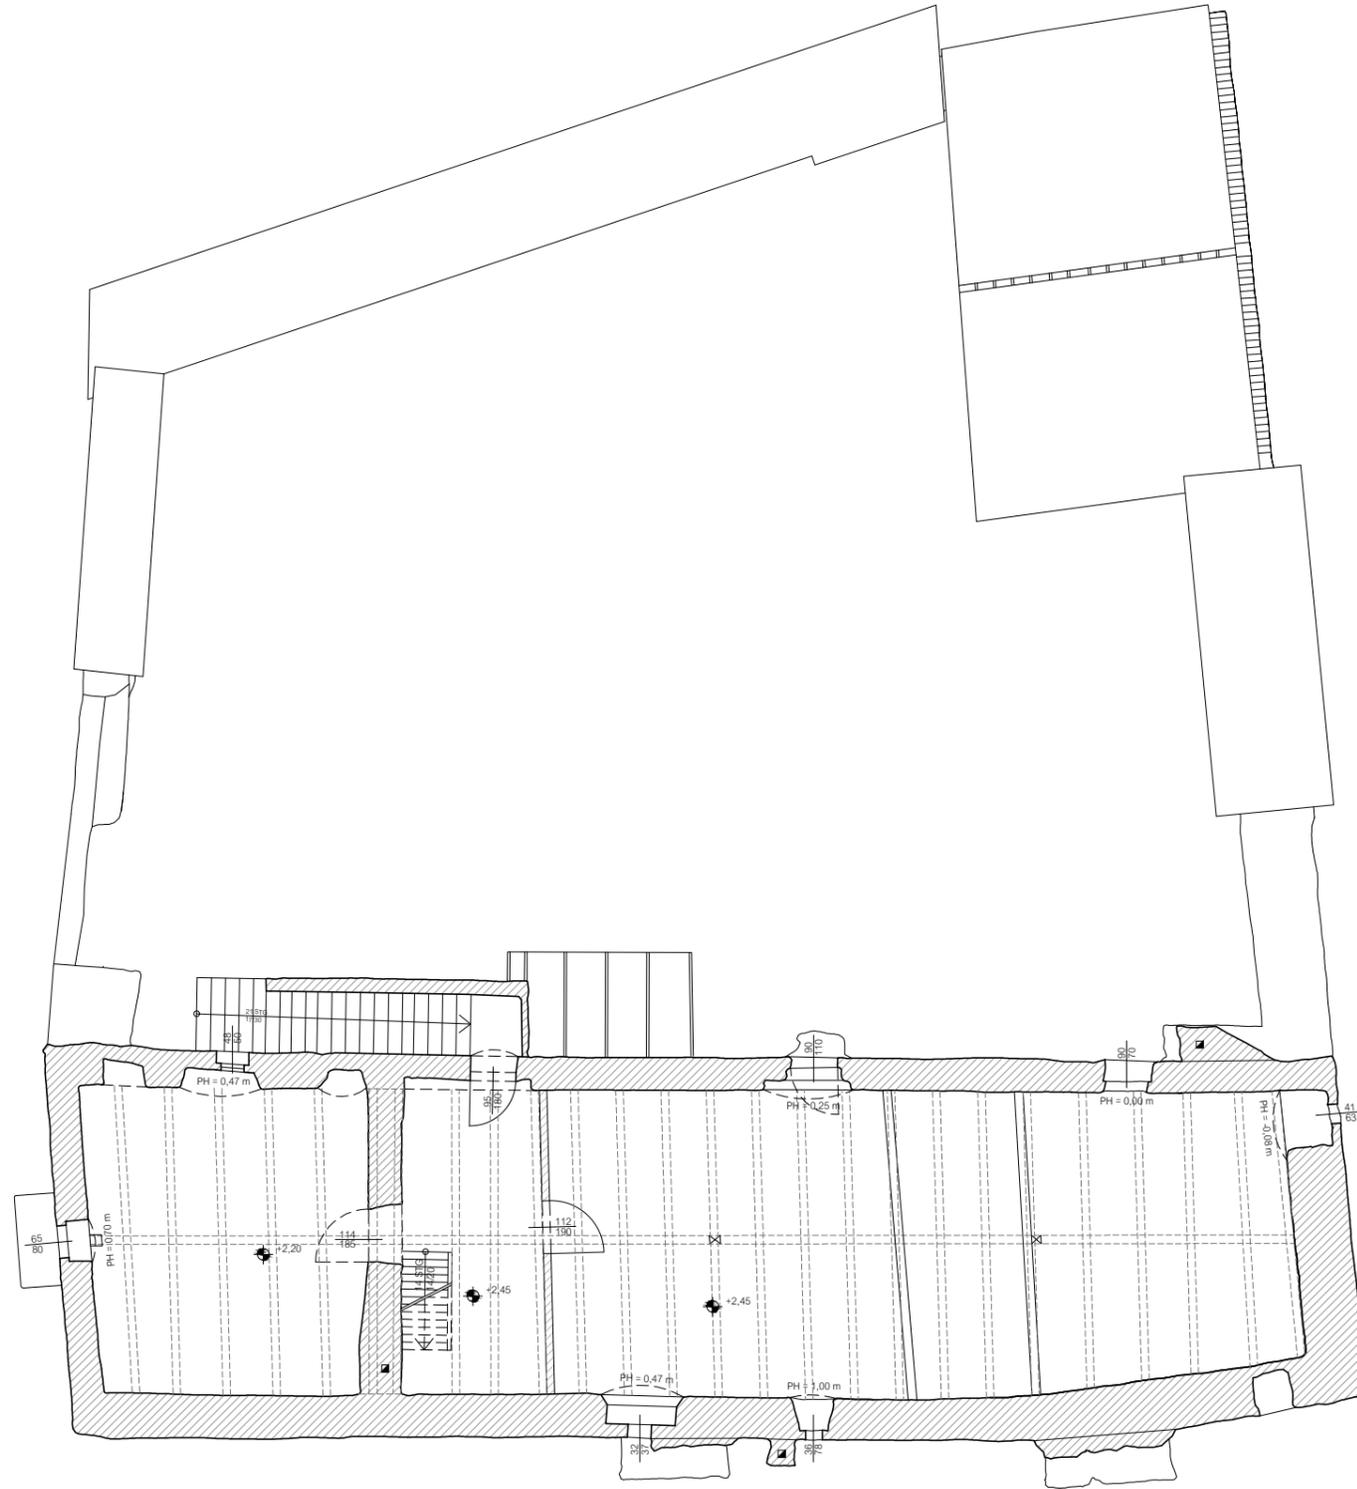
Bestandsplan, Obergeschoß, M 1:150
